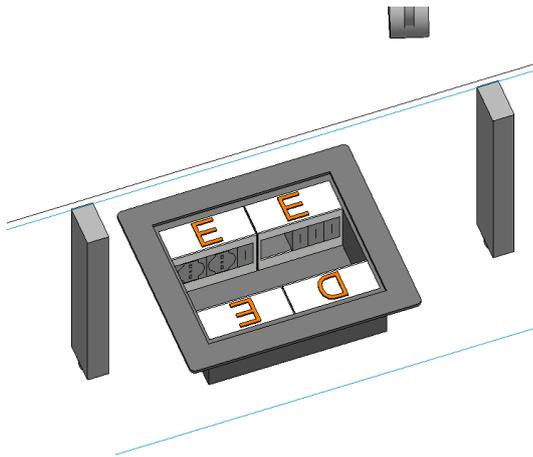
Vista 3D della famiglia della torretta a pavimento
